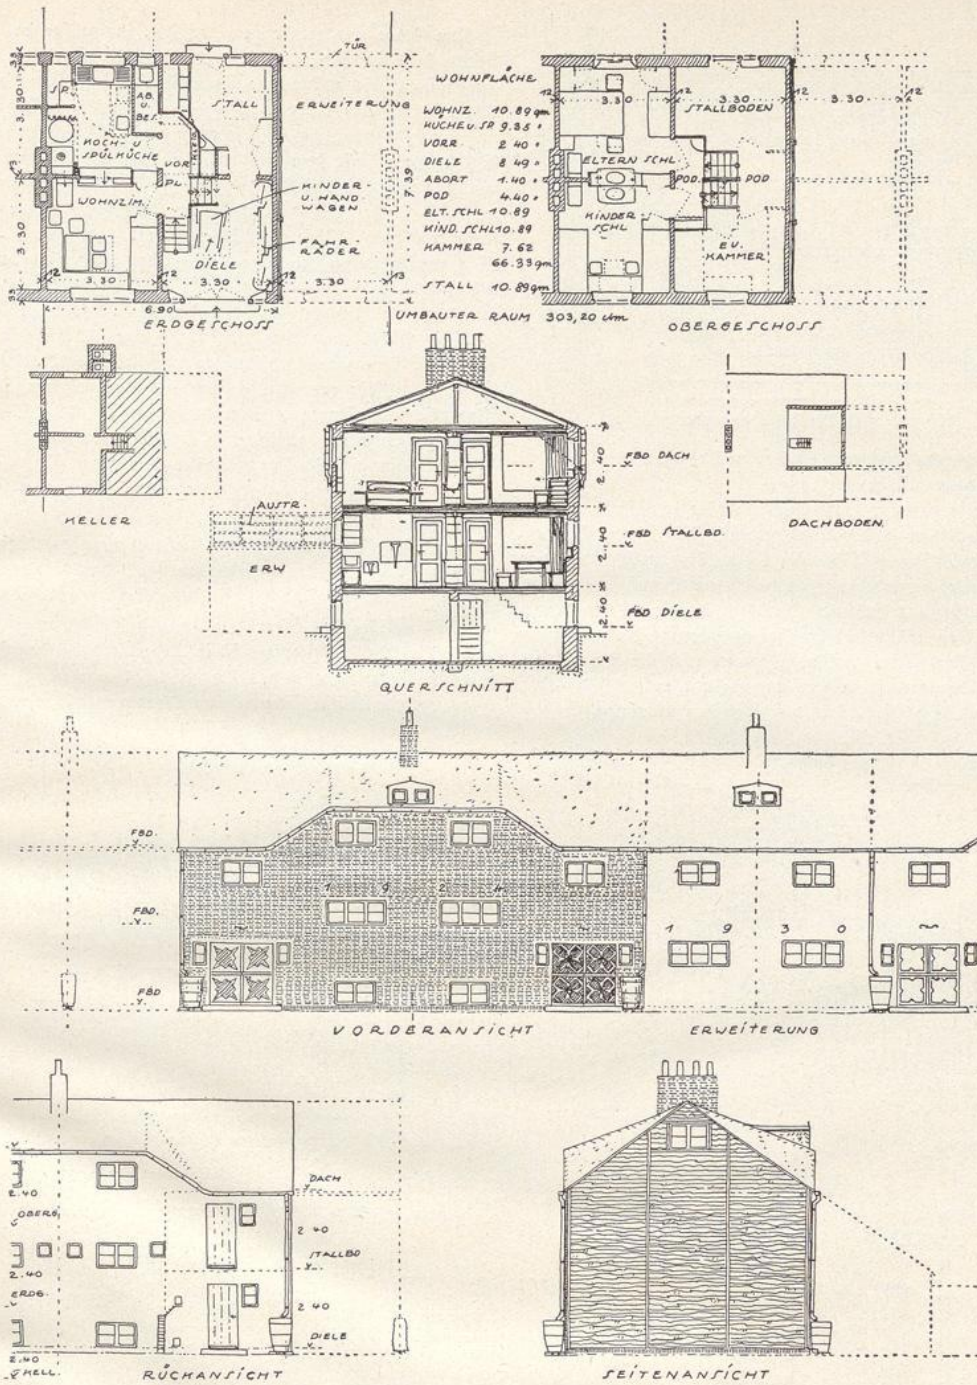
Grundrisse, Schnitte und Ansichten des Handarbeiterhauses. (1:200.)
